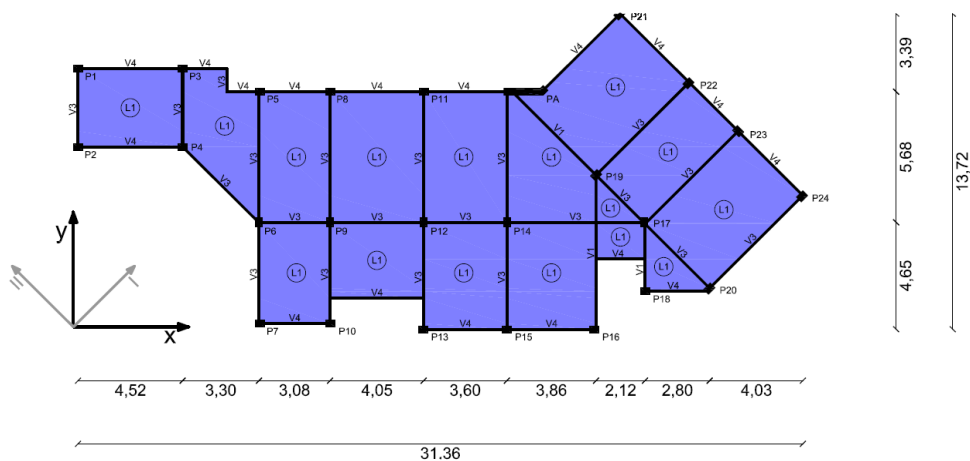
Corpo VII, cobertura, dimensões em metros
